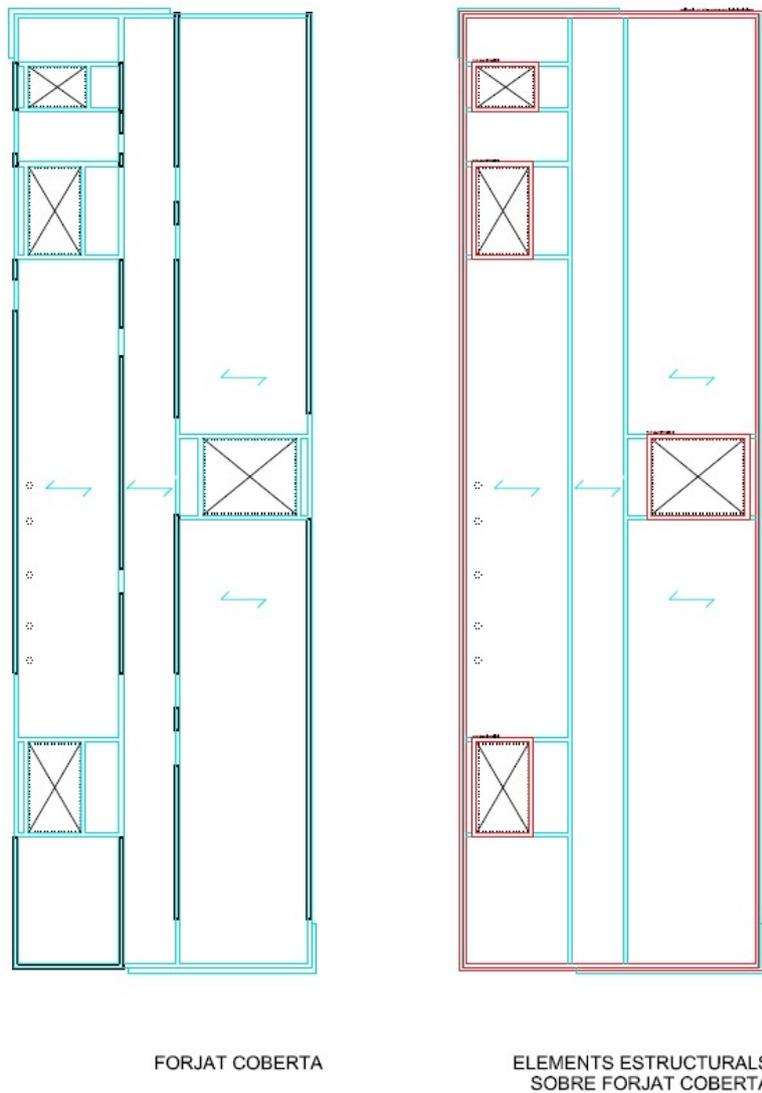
Forjado de cubierta y elementos estructurales sobre el forjado de cubierta previstos en el anteproyecto.
